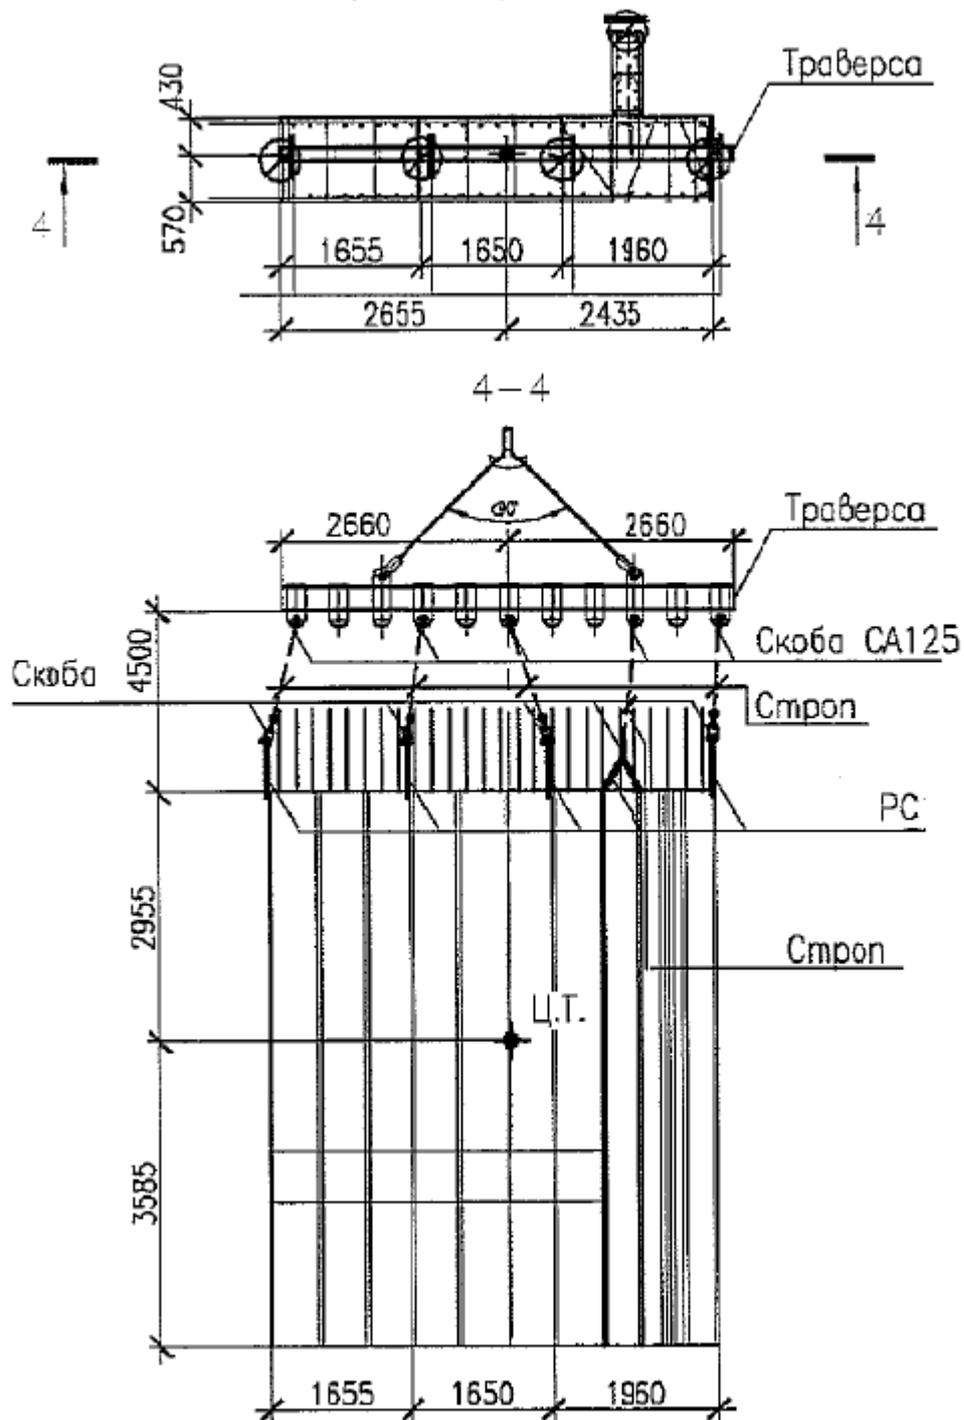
Схемы строповки армоблоков внутренних стен (справочные)
